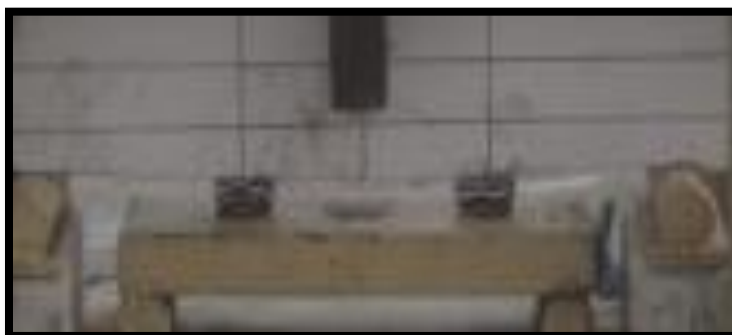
Fisuras en las probetas ensayadas
